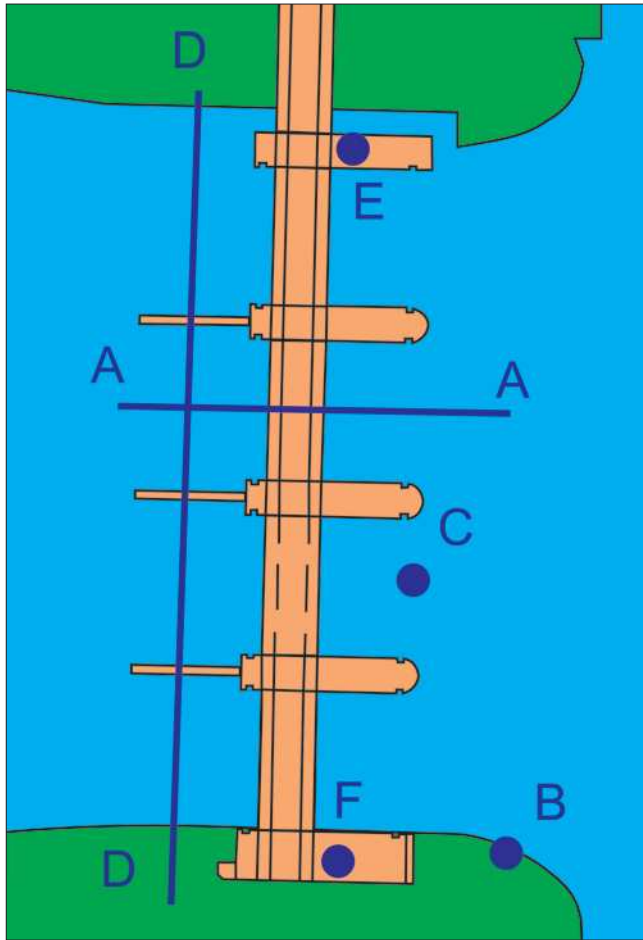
Grundriss der Wehranlage Raffelberg (Neubau)
